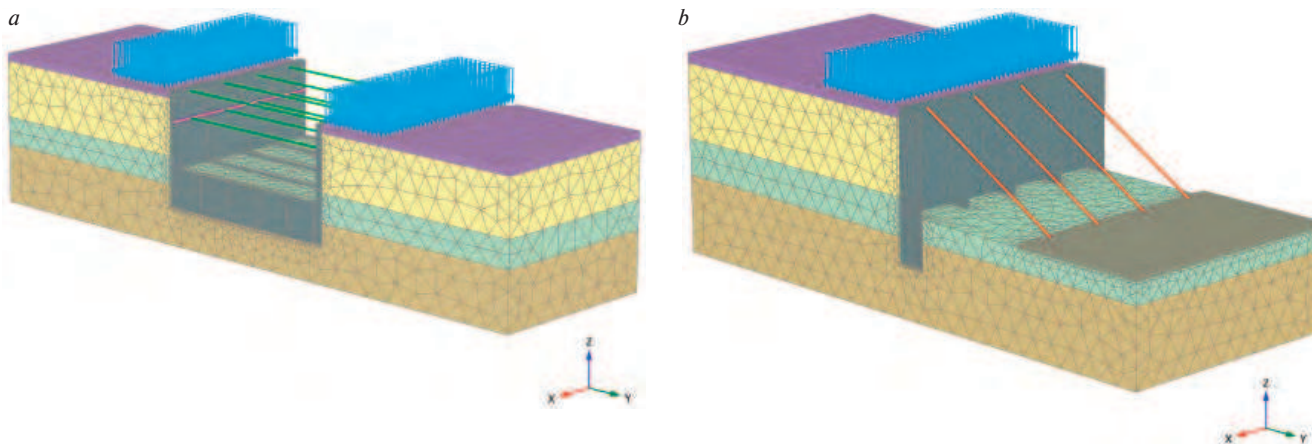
Расчетные схемы: а – котлован с распорками; б – котлован с подкосами
